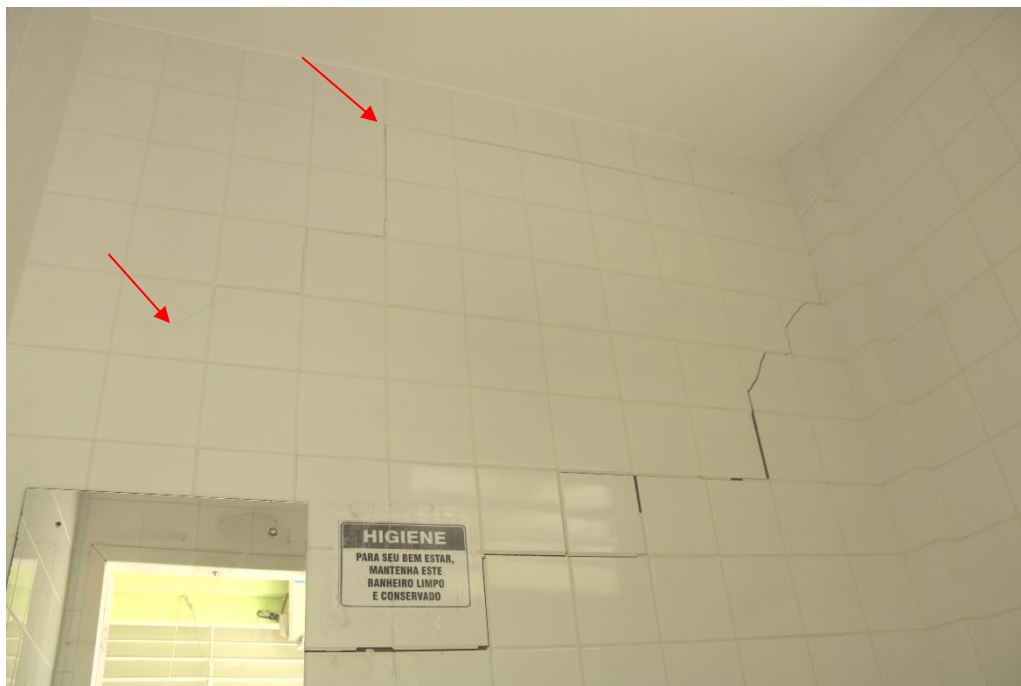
Em detalhe a Foto prévia, destacando trincas diagonais no revestimento cerâmico e, por obvio, na alvenaria.
